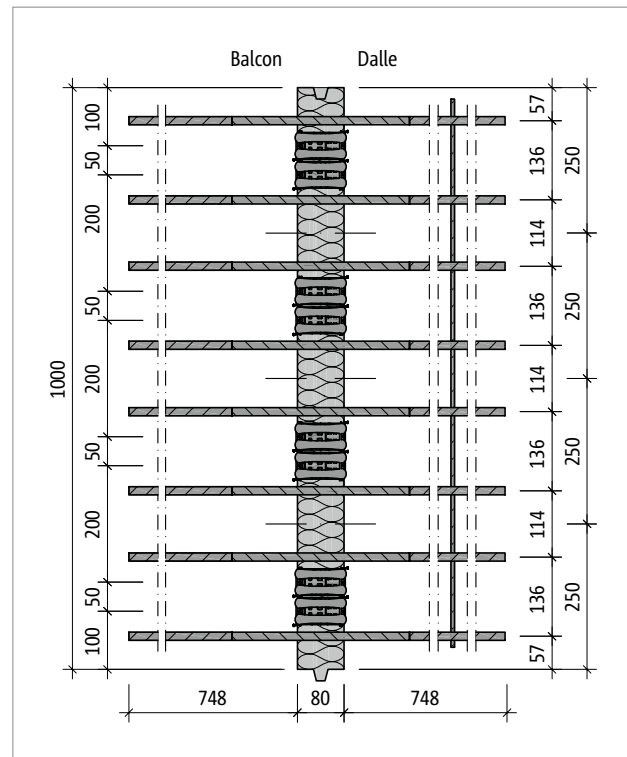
Schöck Isokorb® T type Q-E-V7 : plan de base du produit
